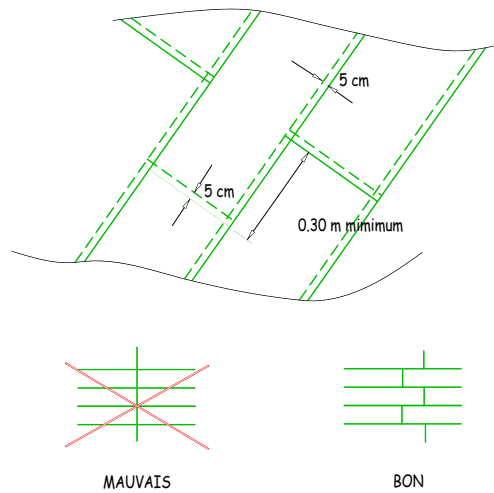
Dispositions relatives à la soudure des lés
